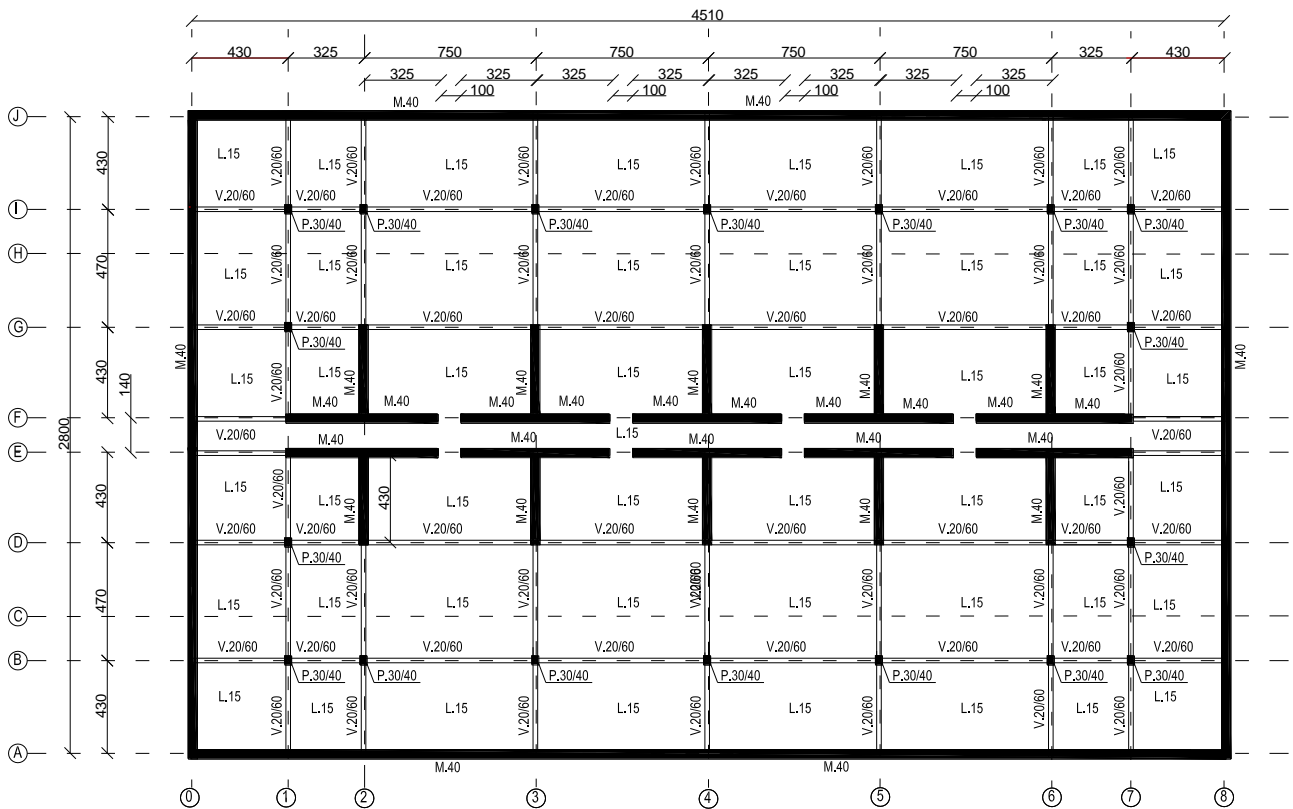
Planta estructura subterráneo, edificio tradicional.
